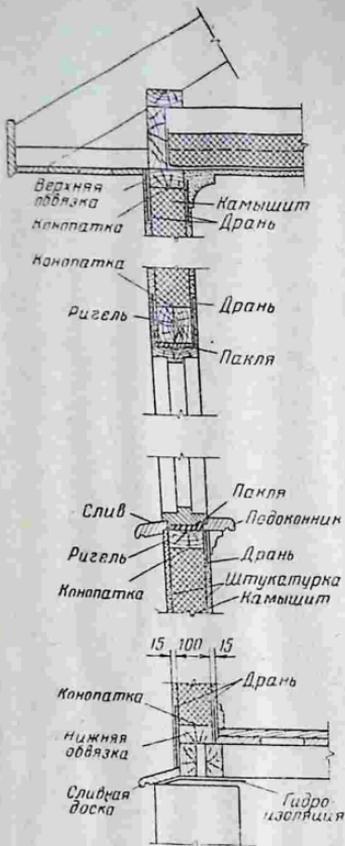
Вертикальный разрез каркасно-камышитовой стены.
